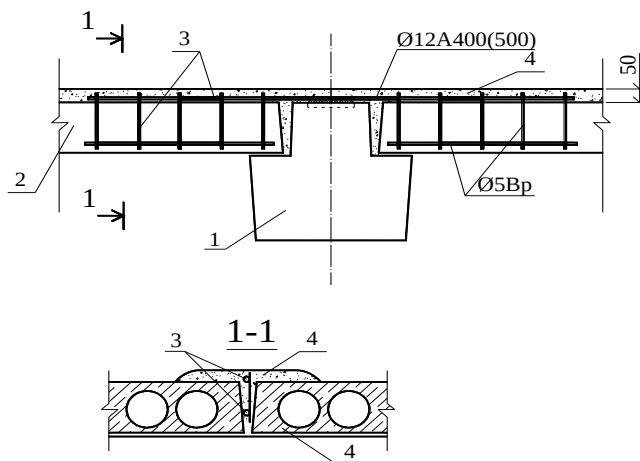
Установка в швы между многопустотными плитами плоских каркасов: 1 – ригель; 2 – плита; 3 – каркас; 4 – набетонка из тяжелого бетона
